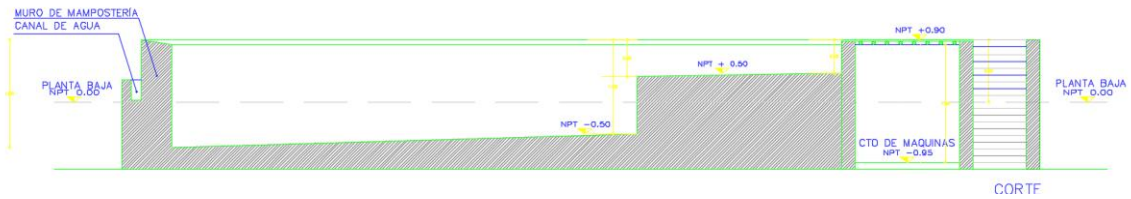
Plano con la ubicación de la alberca y planta de tratamiento
